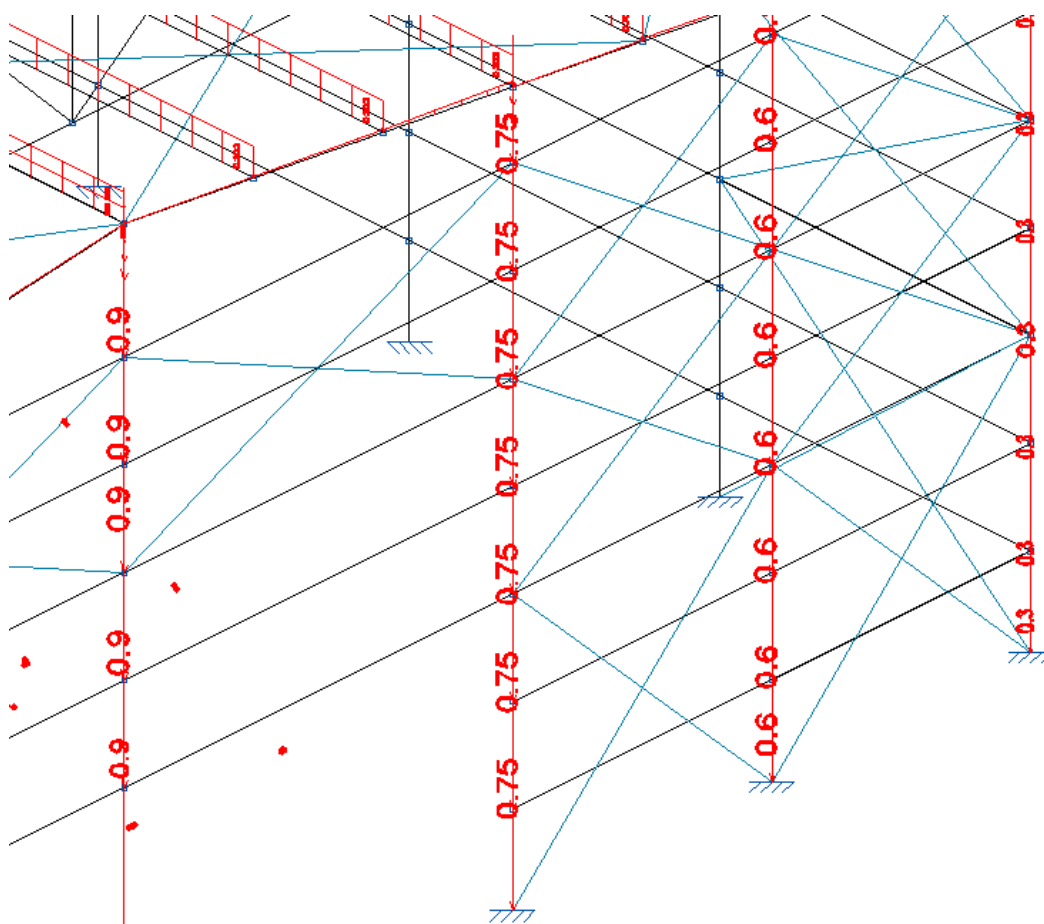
Cargas del cerramiento de fachada sobre fachadas frontal y trasera
